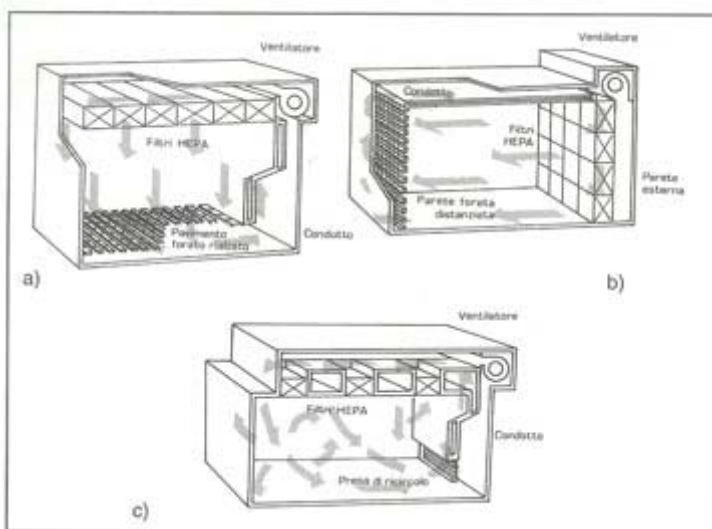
Camere bianche a flusso laminare con distribuzione dell'aria a) dal soffitto (verticale) e b) da parete (orizzontale). (M.D.H.)
